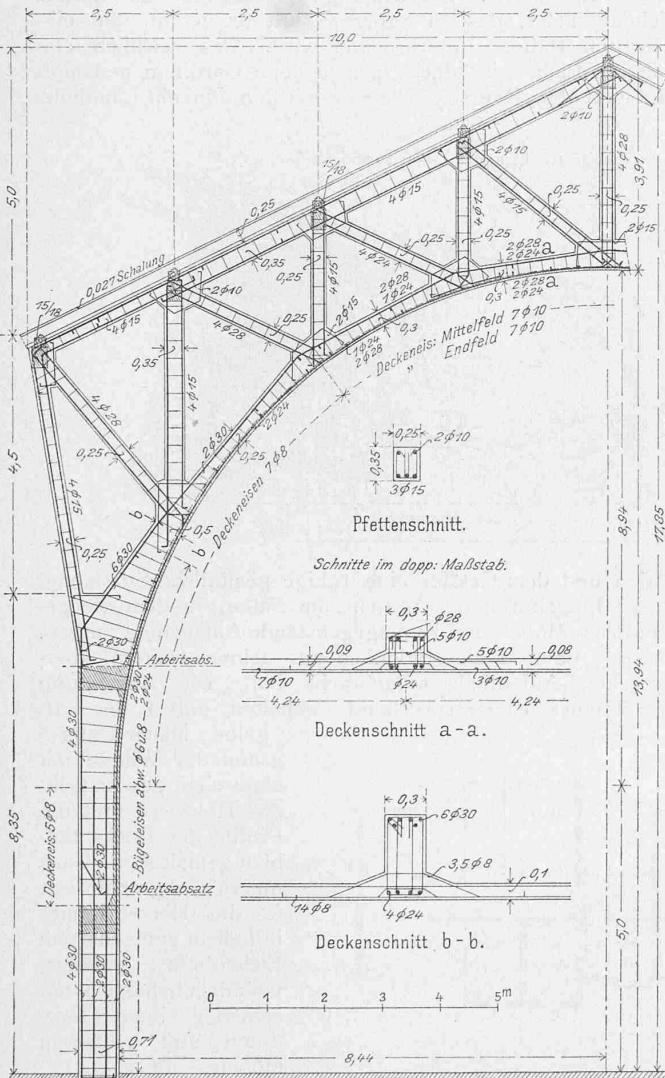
Fachwerk-Bogenbinder der Eingangshalle (etwa 1 : 120).
